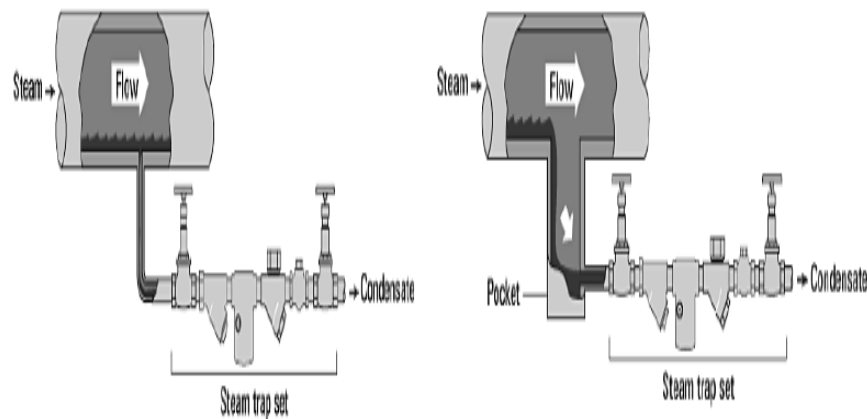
Dimensionamiento correcto e incorrecto del “bolsillo”.
